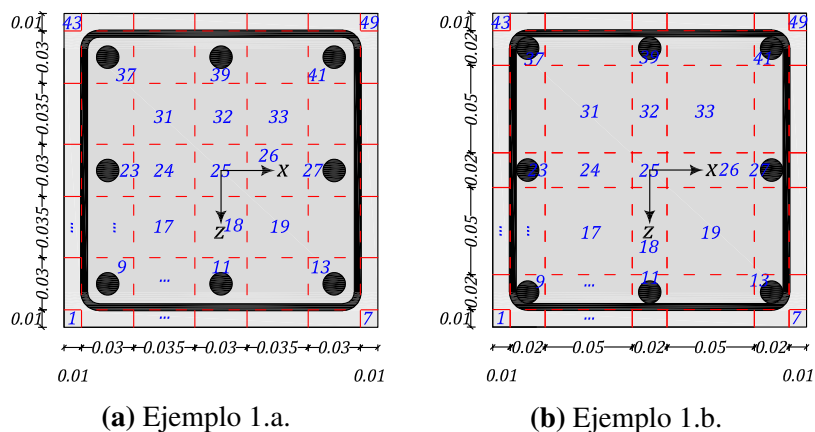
Ejemplos de discretización para la sección transversal según la cantidad y tamaño de los prismas de hormigón armado.
